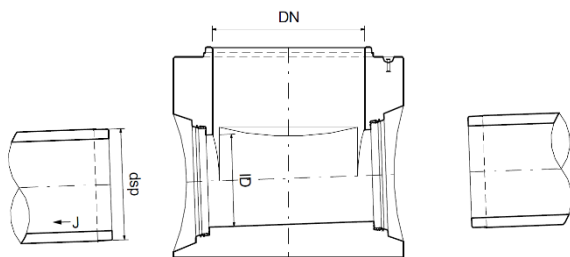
Anschluss mit POLYCRETE® Polymerbetonrohre mit Gefälle J ≤ 150 ‰
